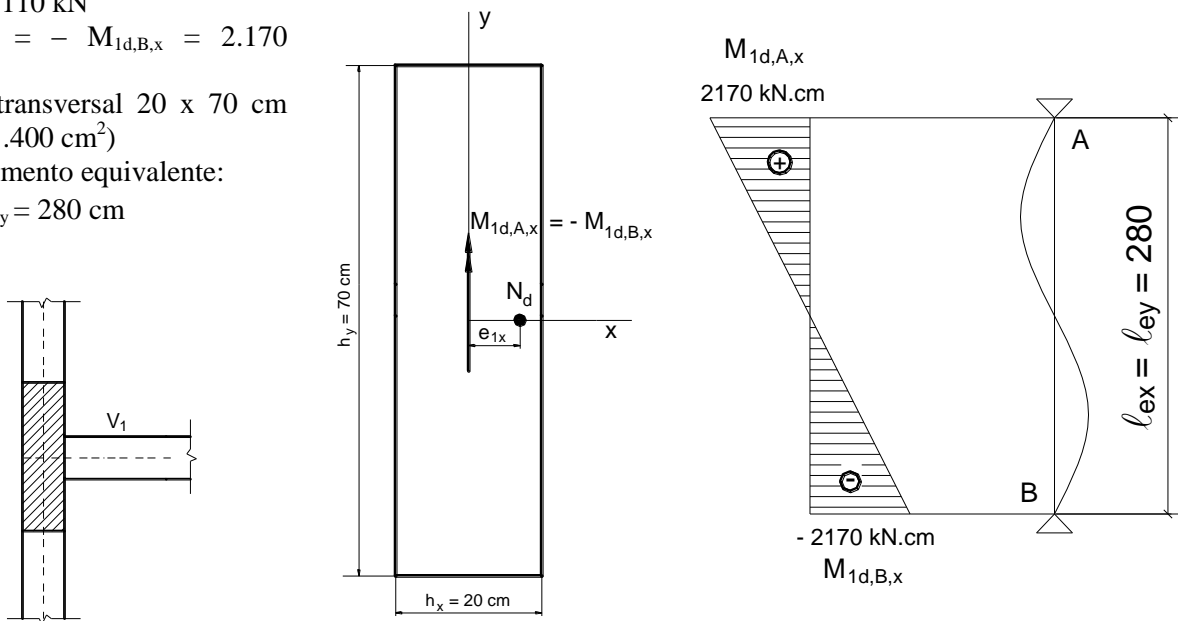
Arranjo estrutural do pilar na planta de fôrma, dimensões da seção transversal e momentos fletores de cálculo de 1ª ordem atuantes na direção x do pilar.
